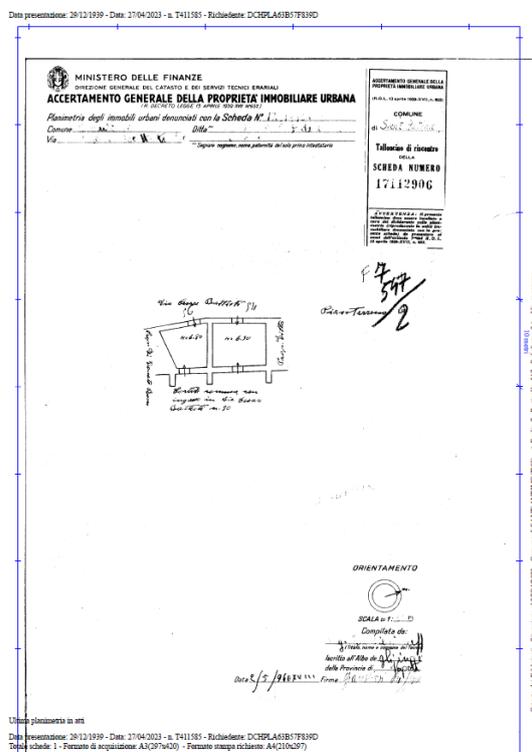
Planimetria d'impianto del Sub 2, depositata in Catasto nel 1939.
